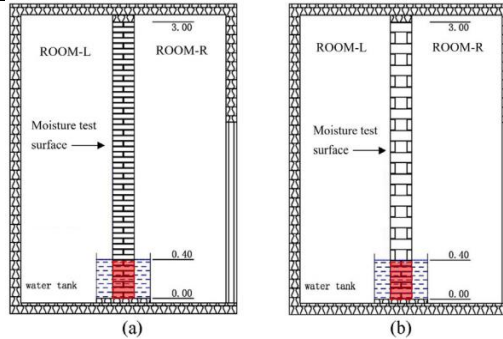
(a) Sección de muro macizo. (b) sección de pared de cavidad
